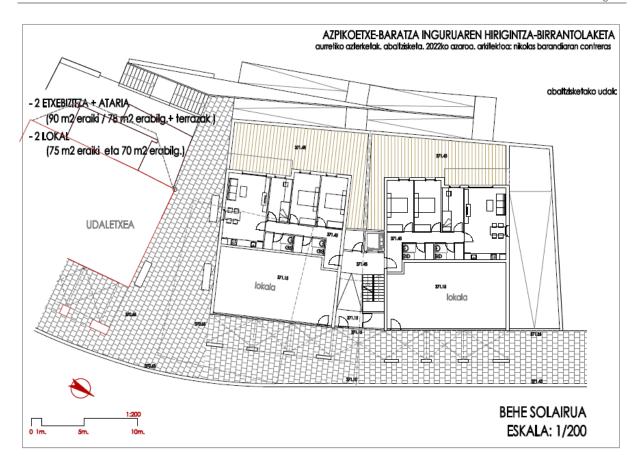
Ordenación en planta baja propuesta. Fuente: Anteproyecto de viviendas.
